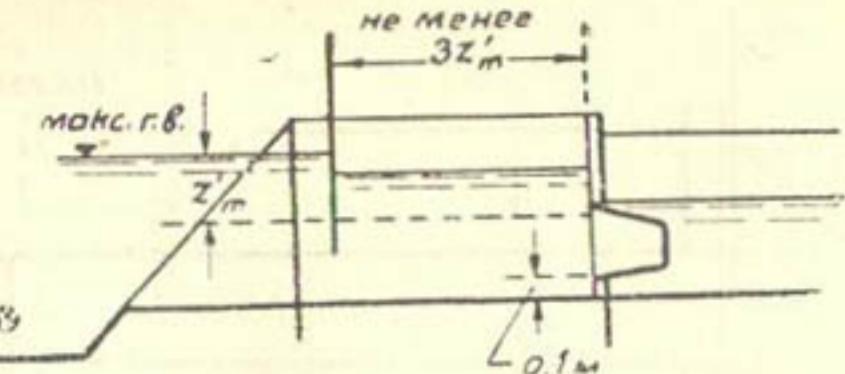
Водовыпуск с насадком *a* (квадратное и прямоугольное сечение), *d* (круглое сечение) — от 0,1 до 0,25 м
